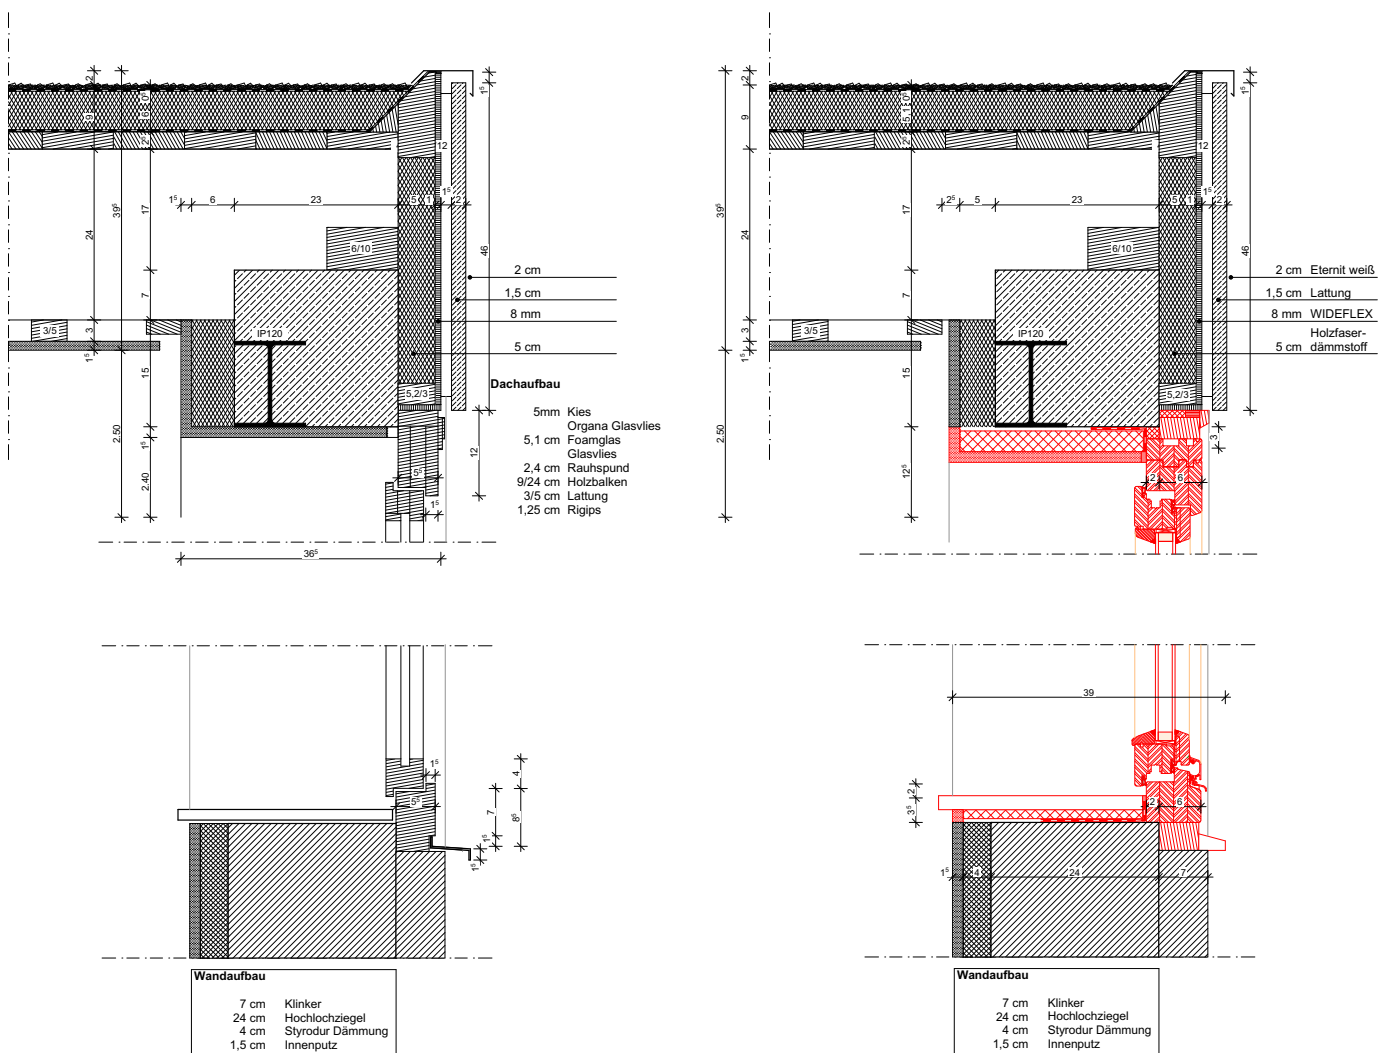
Vertikalschnitt Konstruktionsvorschlag Neueinbau Fenster
